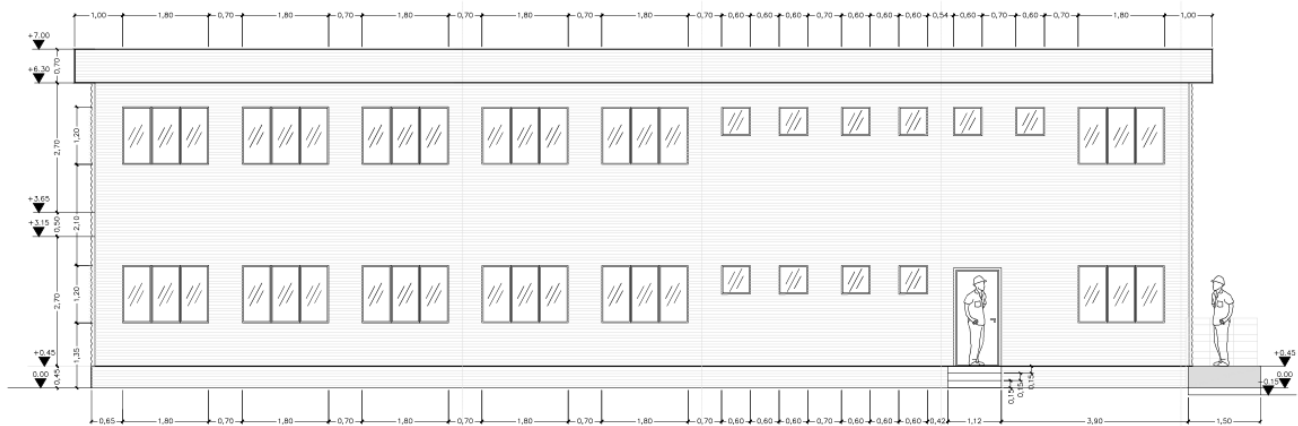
Fabbricato Impresa ferroviaria ed Impresa manovra: Prospetto
